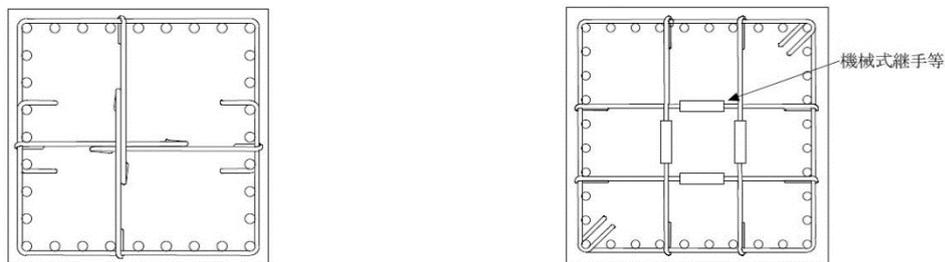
継手を用いた中間帯鉄筋の配筋例（道示編，IV図-解 5.2.2）
